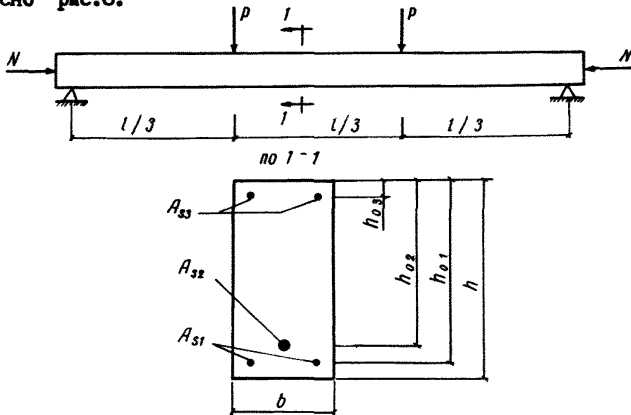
Схема нагружения и армирования железобетонного ригеля
